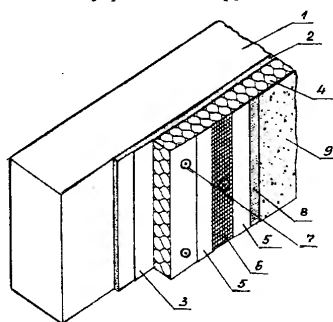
Конструкция теплозвукоизоляции стен системы «Шуба»: 1 – несущая стена; 2 – старая штукатурка; 3 – минеральный клеевой состав; 4 – теплоизоляция (плиты пенополистирола – $\lambda=0,041$ Вт/(м^{°С}); 5 – армирующий слой из клеевого состава; 6 – сетка из стекловолокна; 7 – добели; 8 – грунтовка; 9 – фасадное покрытие (минеральная или декоративная штукатурка)
